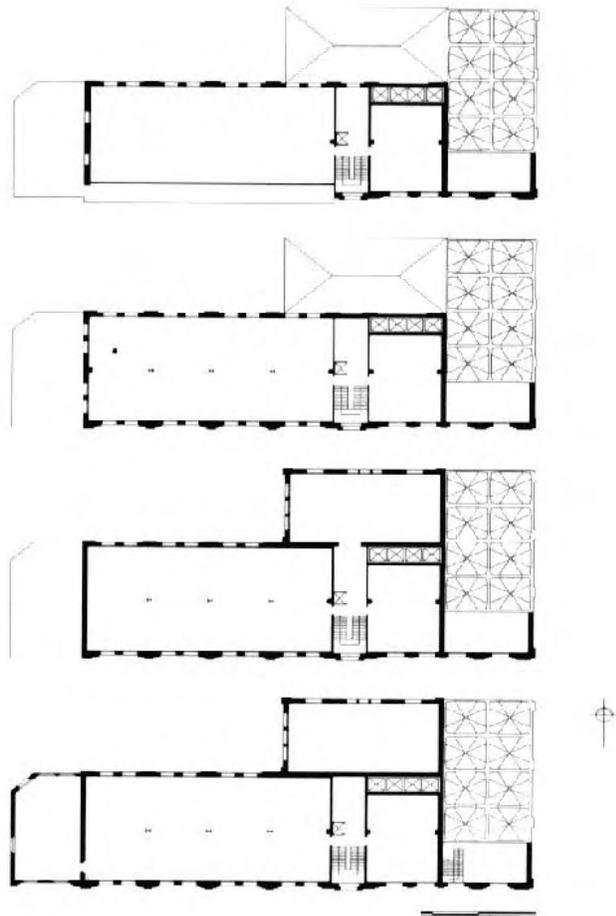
Plantas baixas pavimentos do moinho Pelotense.
